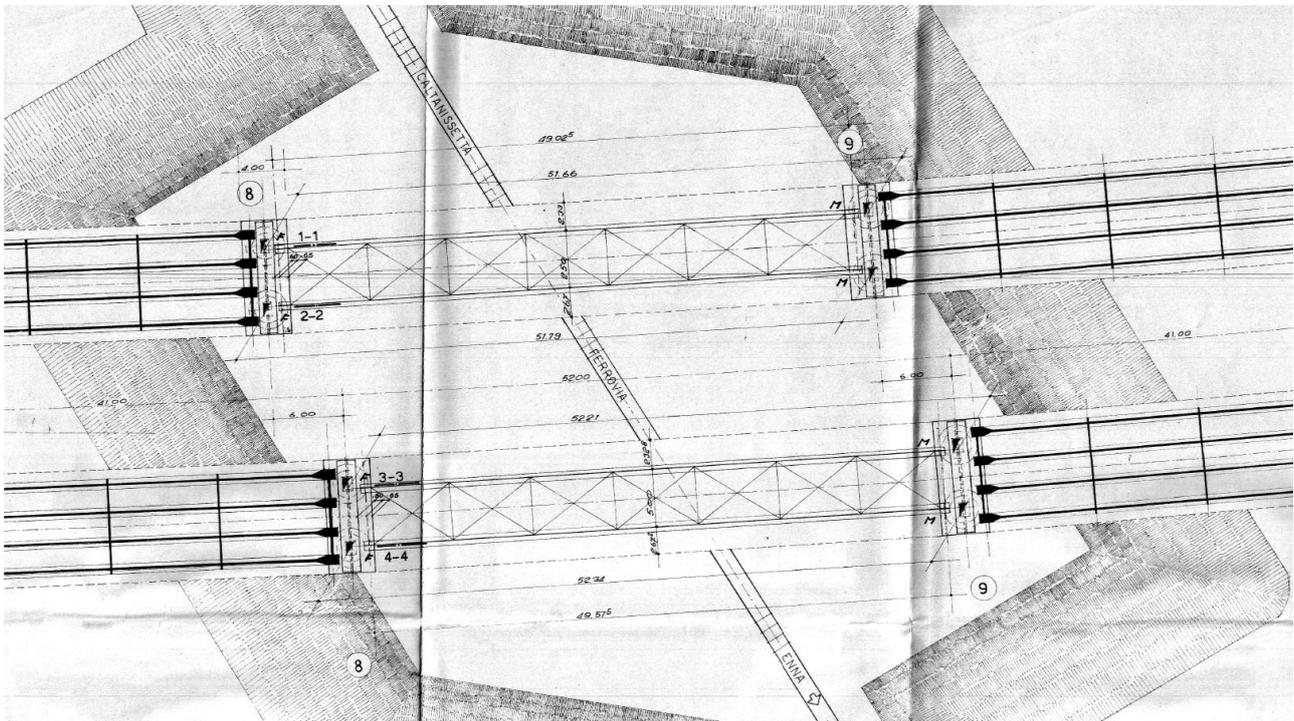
Campate di scavalco linea FS – Pianta ad opere finite
